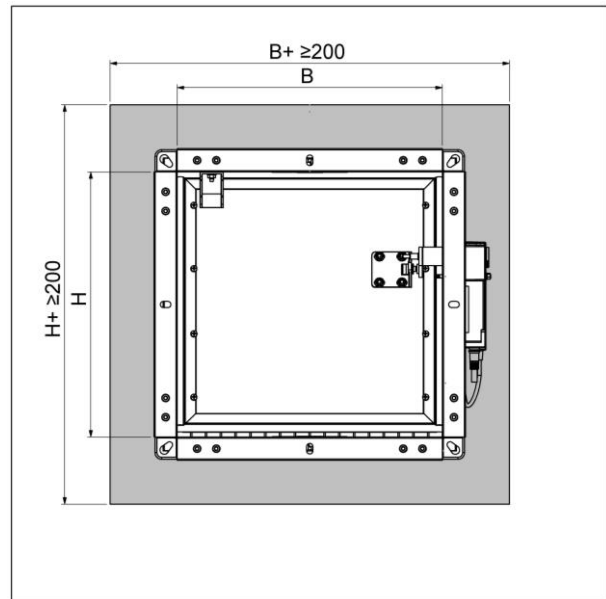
montaggio in soffitti massicci con zoccolo in calcestruzzo, vista dall'alto
